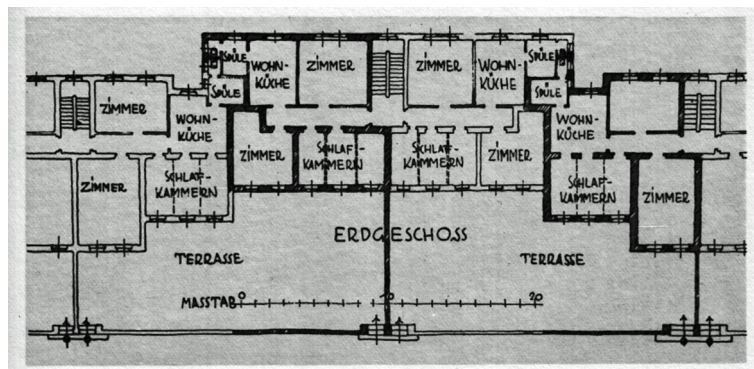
P. Behrens, *Entwurf eines Terrassenhauses*, Grundriss 1920
